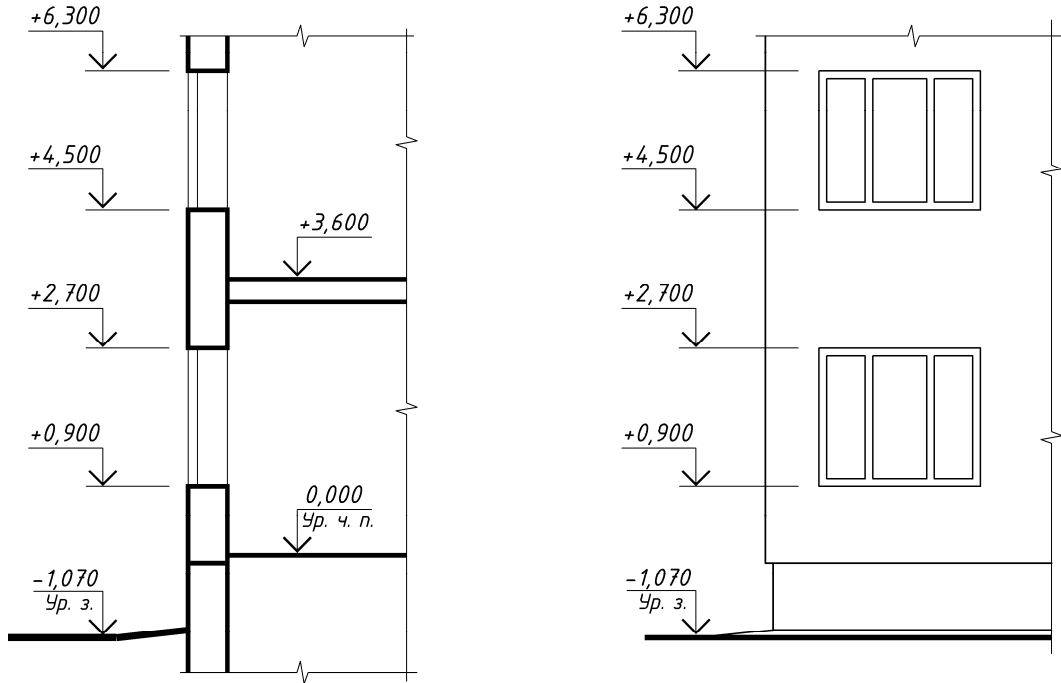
Нанесение высотных отметок на разрезах и фасадах
